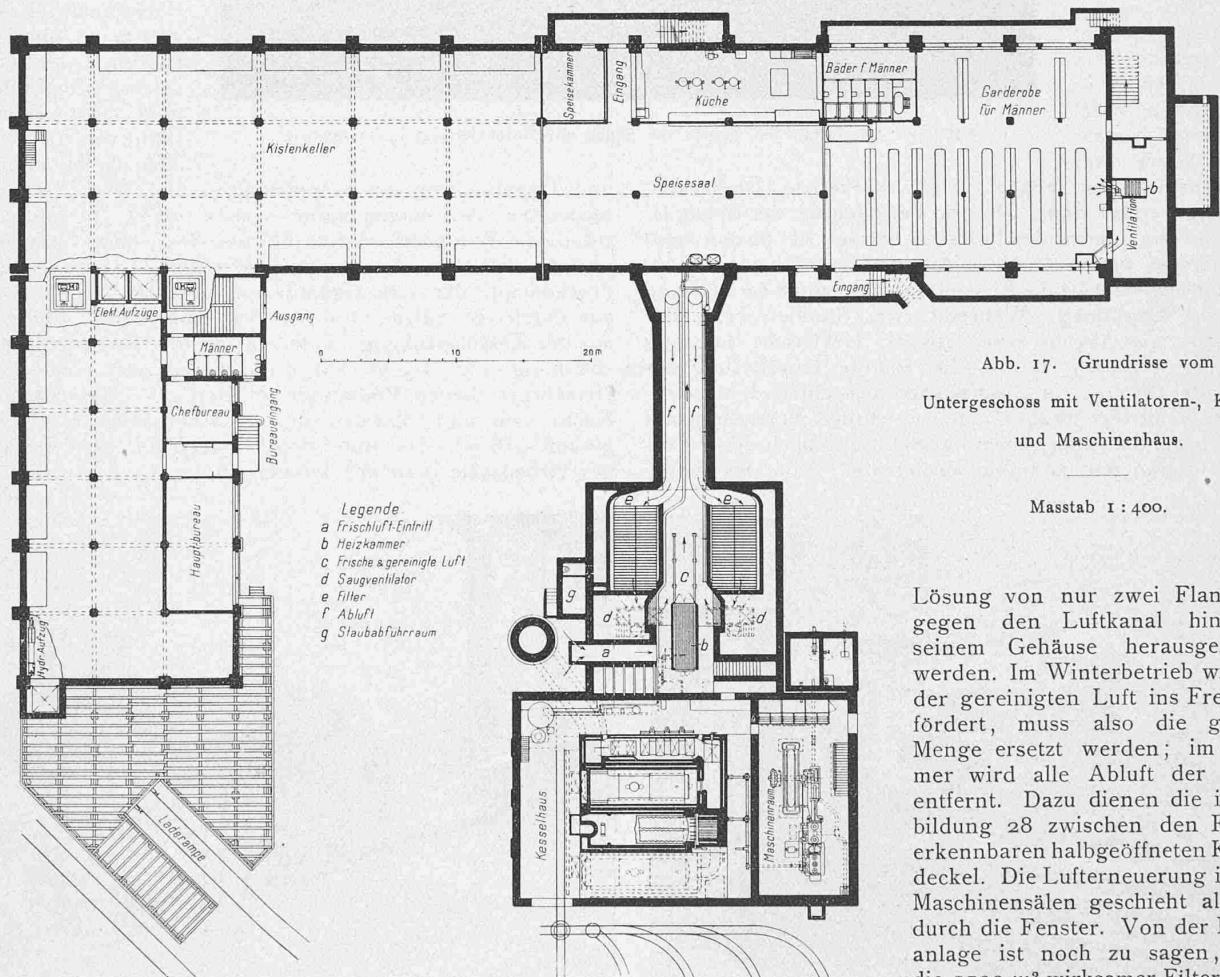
Grundrisse vom Untergeschoss mit Ventilatoren-, Kessel- und Maschinenhaus.
